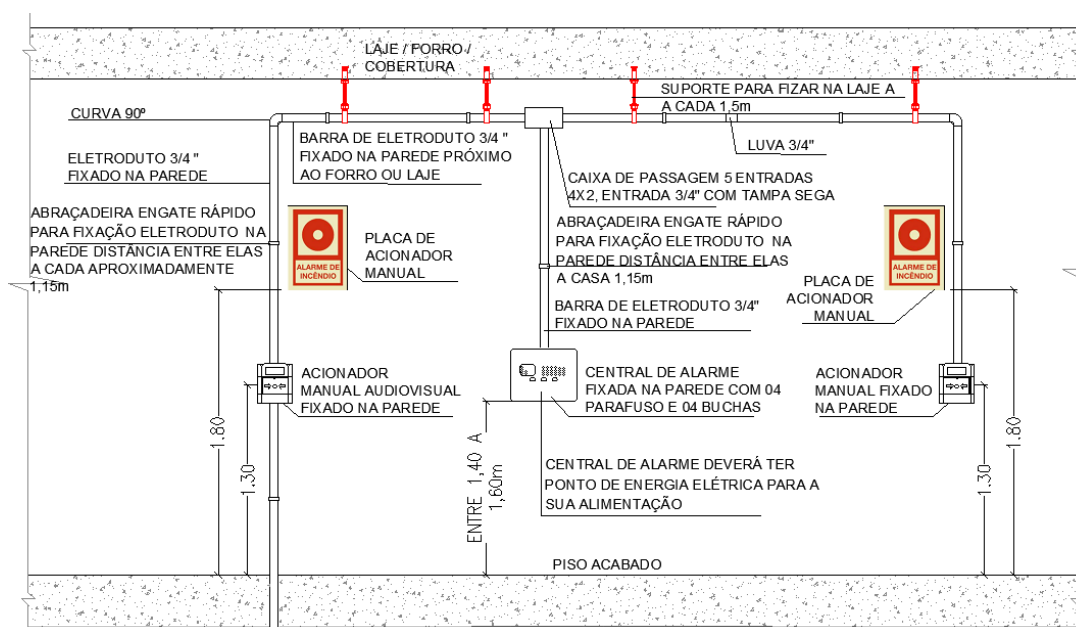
Detalhe esquemático do sistema de alarme fixado na parede (vista)
